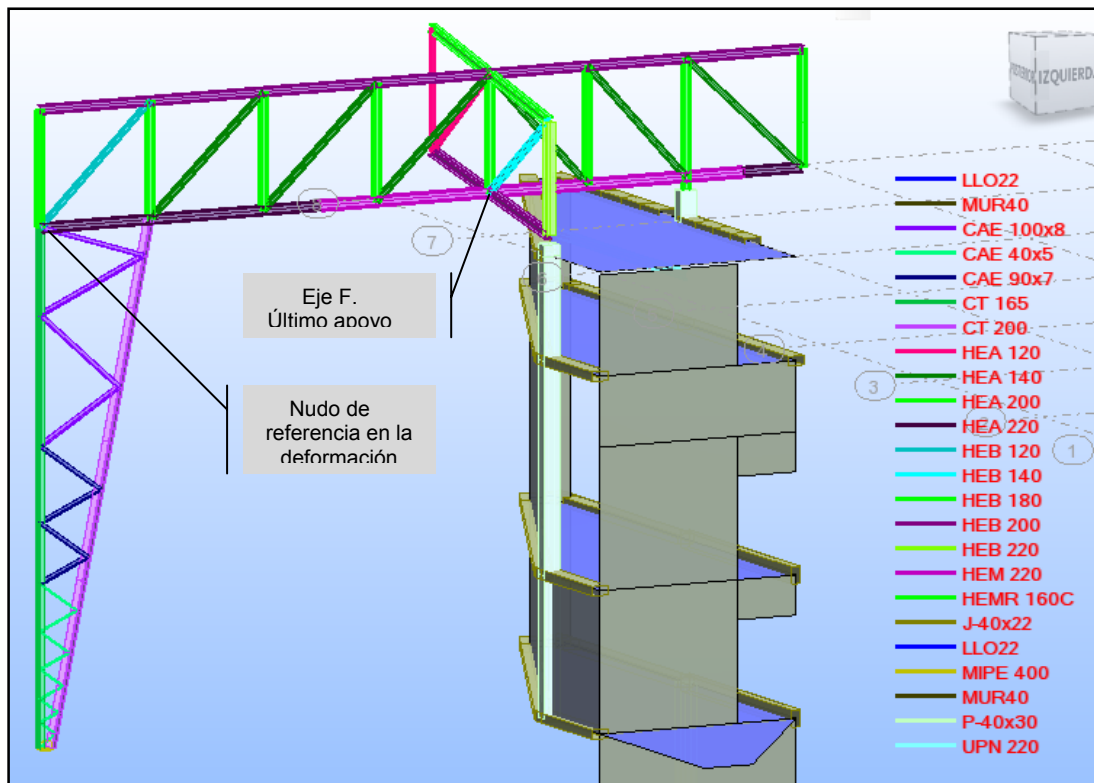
Alzado de voladizo (Modelo estructural del proyecto)
